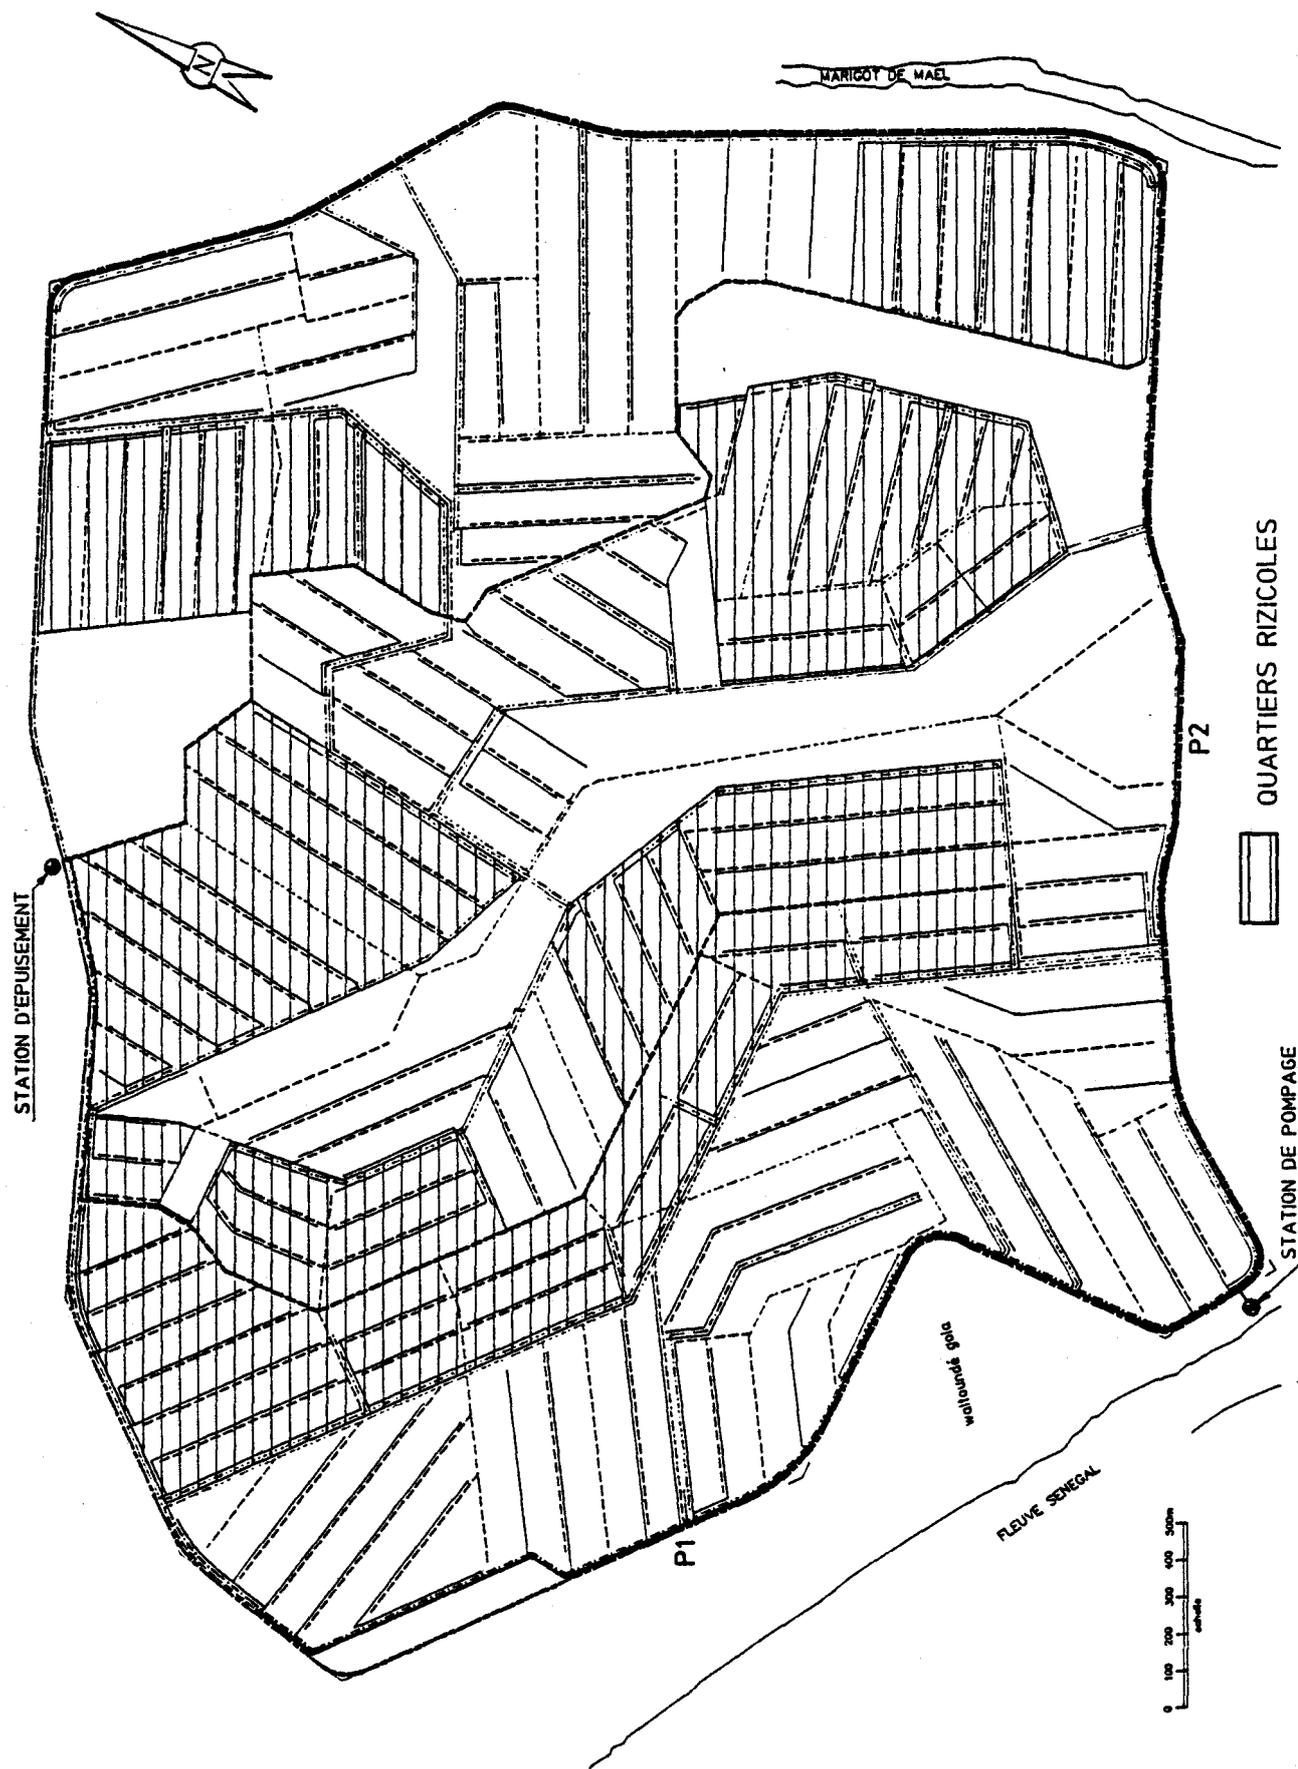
PLAN GENERAL DU RESEAU HYDRAULIQUE
